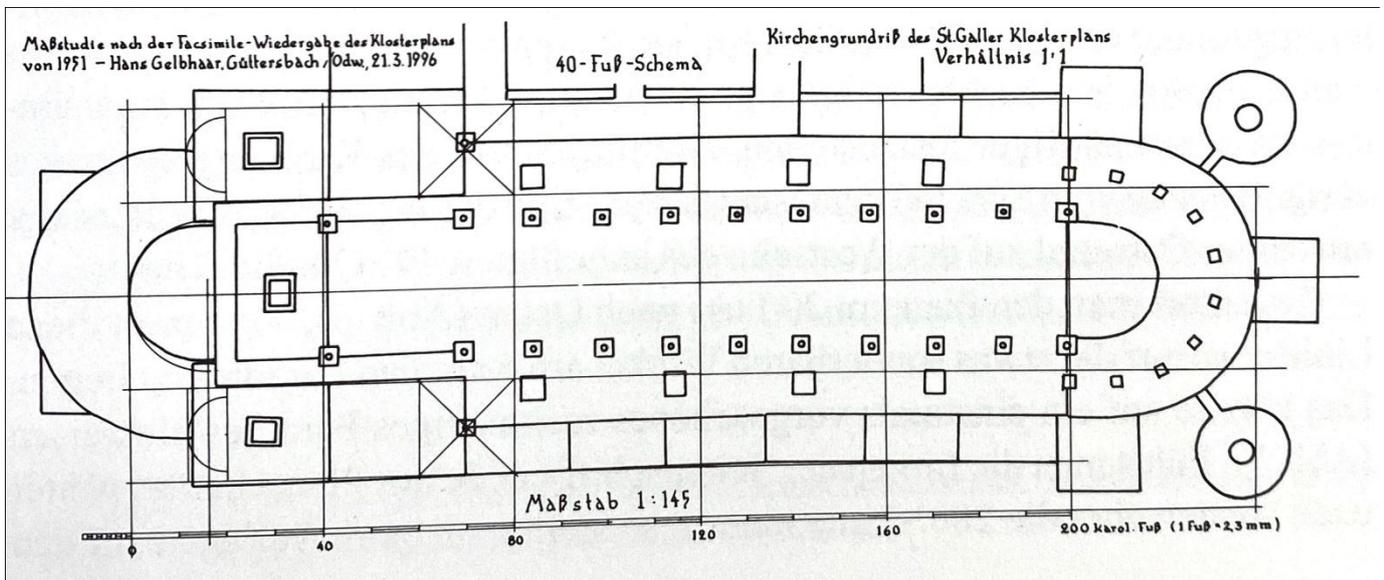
Hans Gelbhaar, Planschema mit 40 Fuß-System auf Kirchengrundriß.
